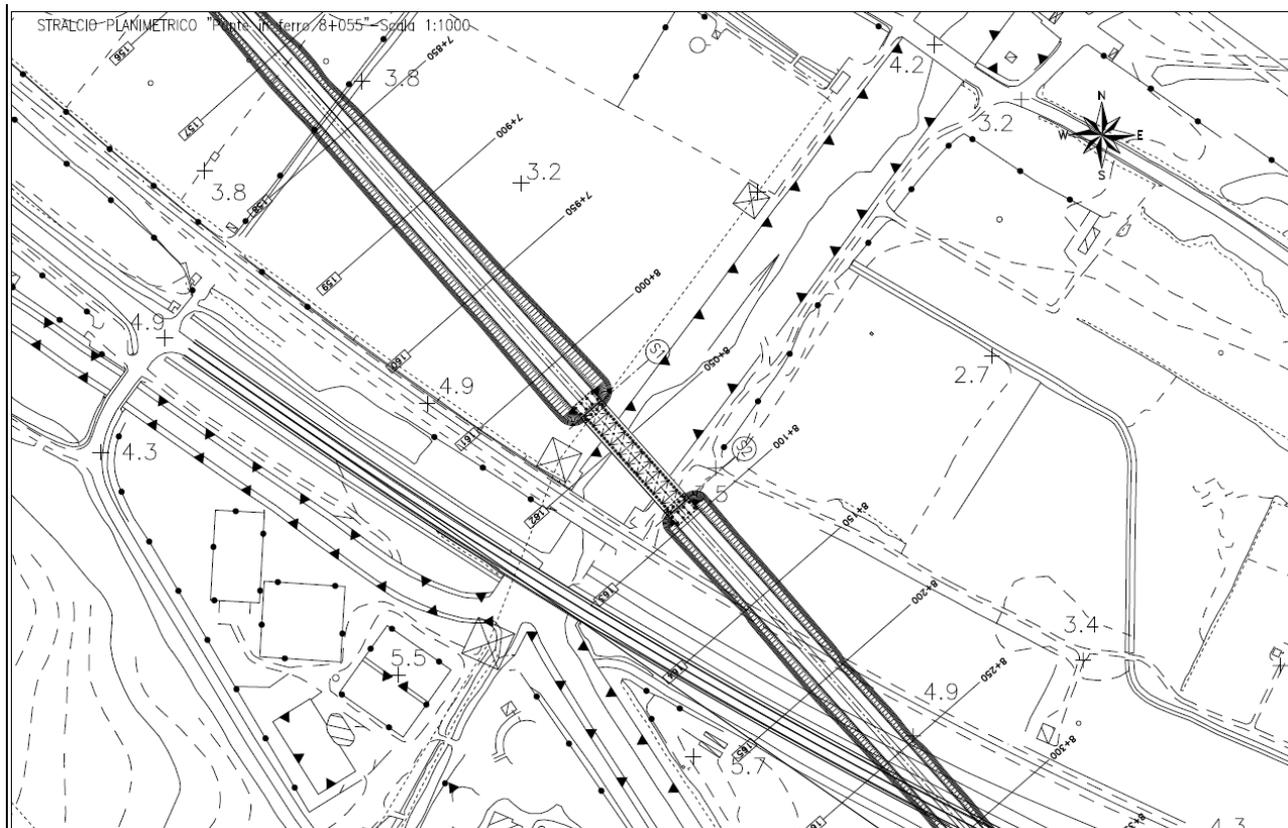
Travata metallica sul collettore "Bonifica di Ramitelli": stralcio planimetrico
